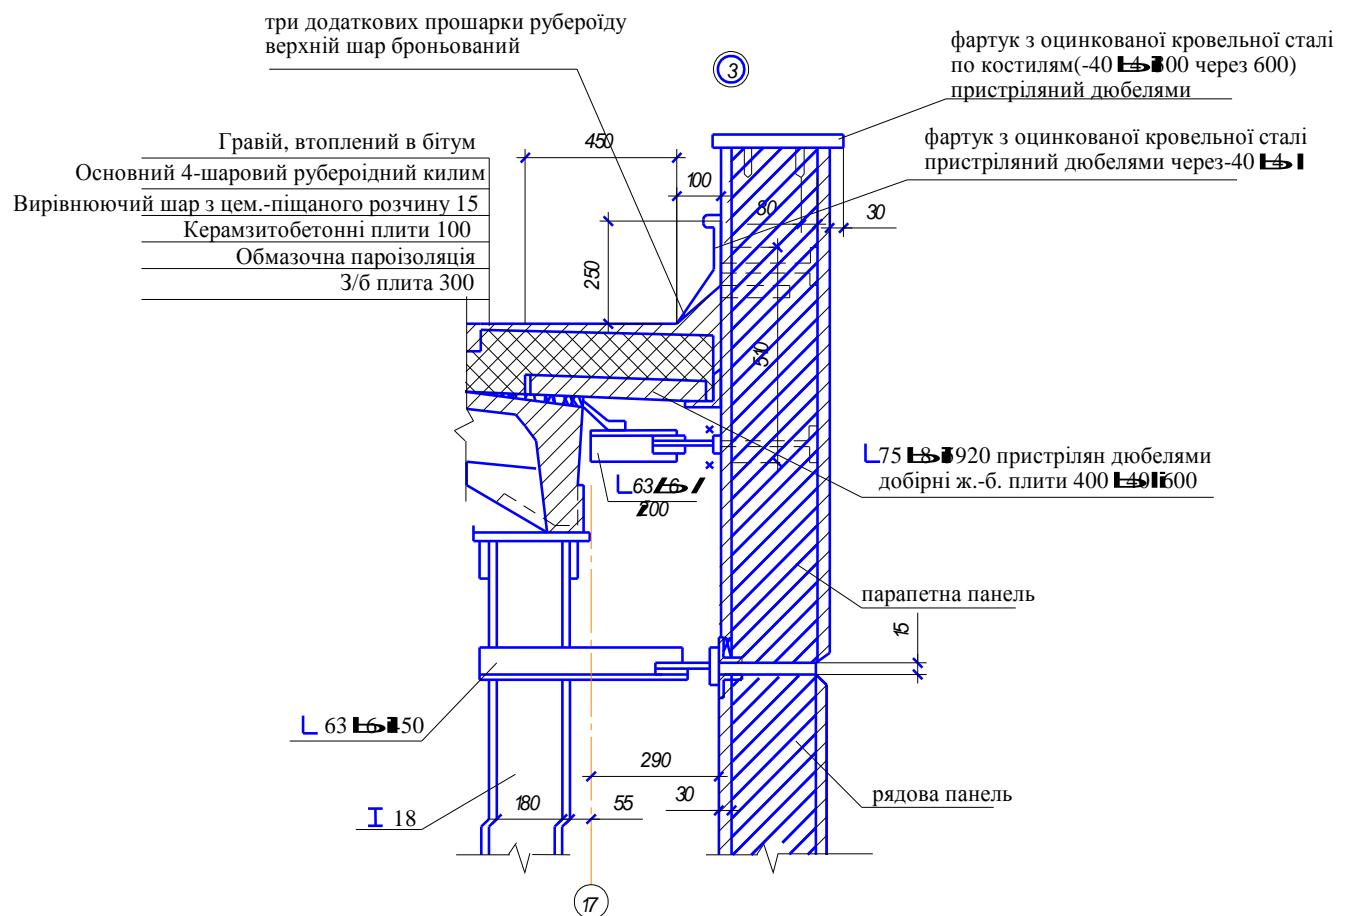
Парапетний вузол одноповерхової будівлі
